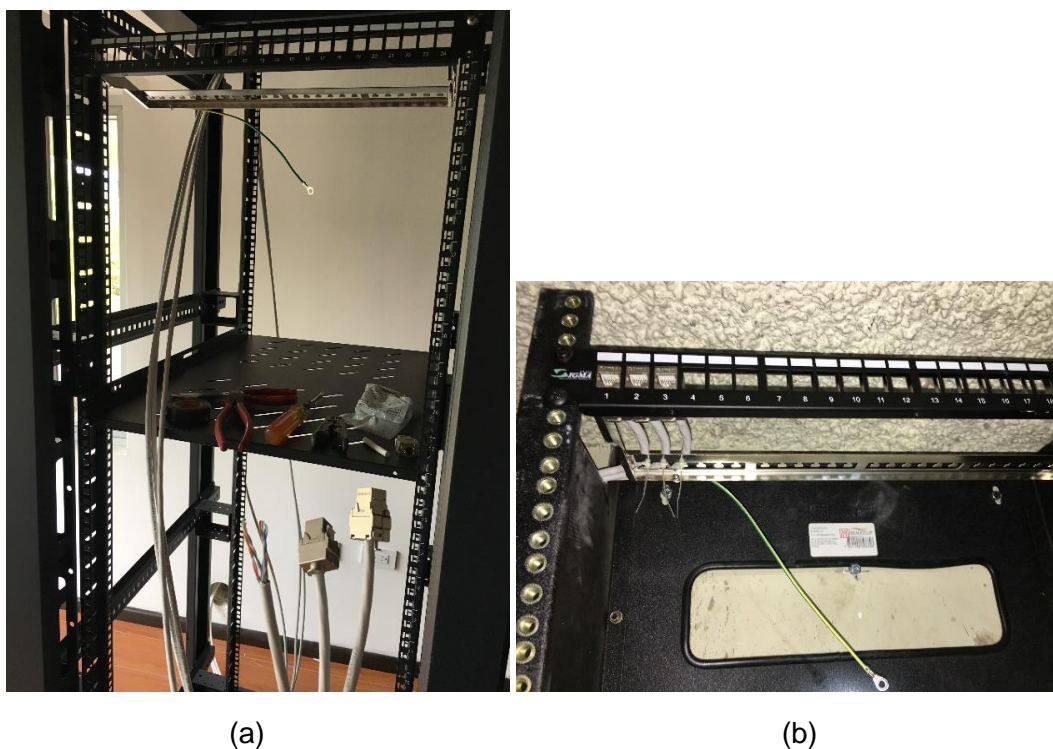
Tendido del cableado e instalación de jacks cat 6A en patch panels.
